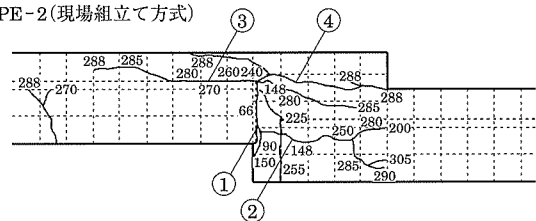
TYPE-1,TYPE-2 中央段差接合梁近傍ひび割れ状況図
